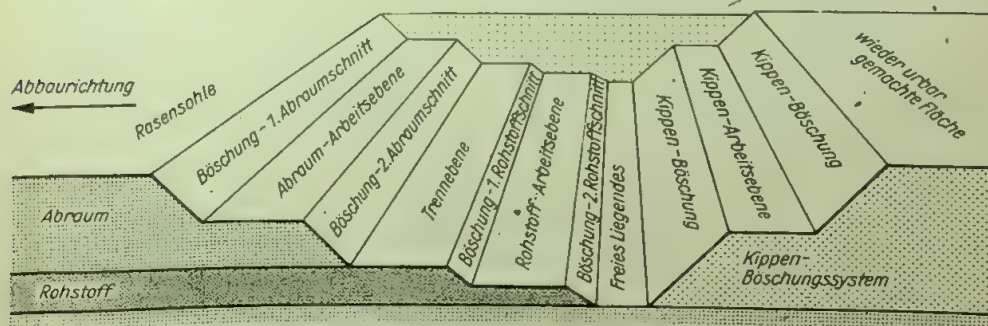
Flächen- und Raumelemente im Tagebau
